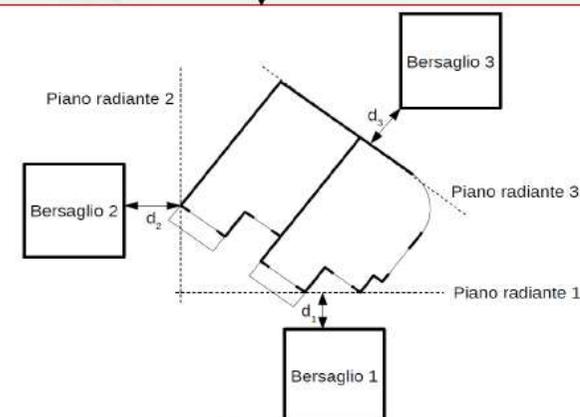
Determinazione del piano radiante (vista in pianta delle costruzioni)
